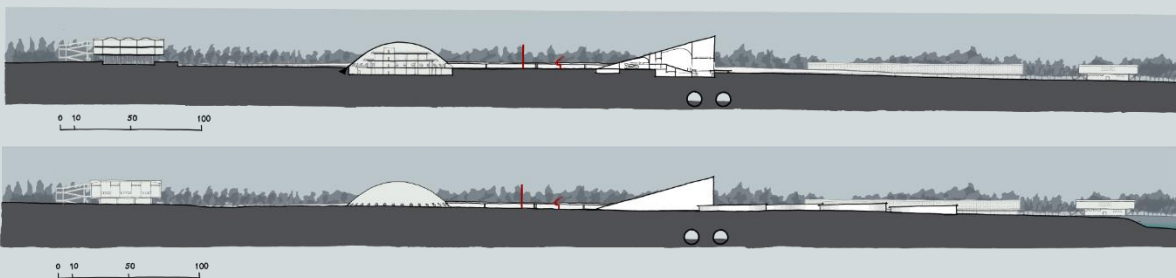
Implantação – 2002 – Versão 04 B – desenho nosso.
